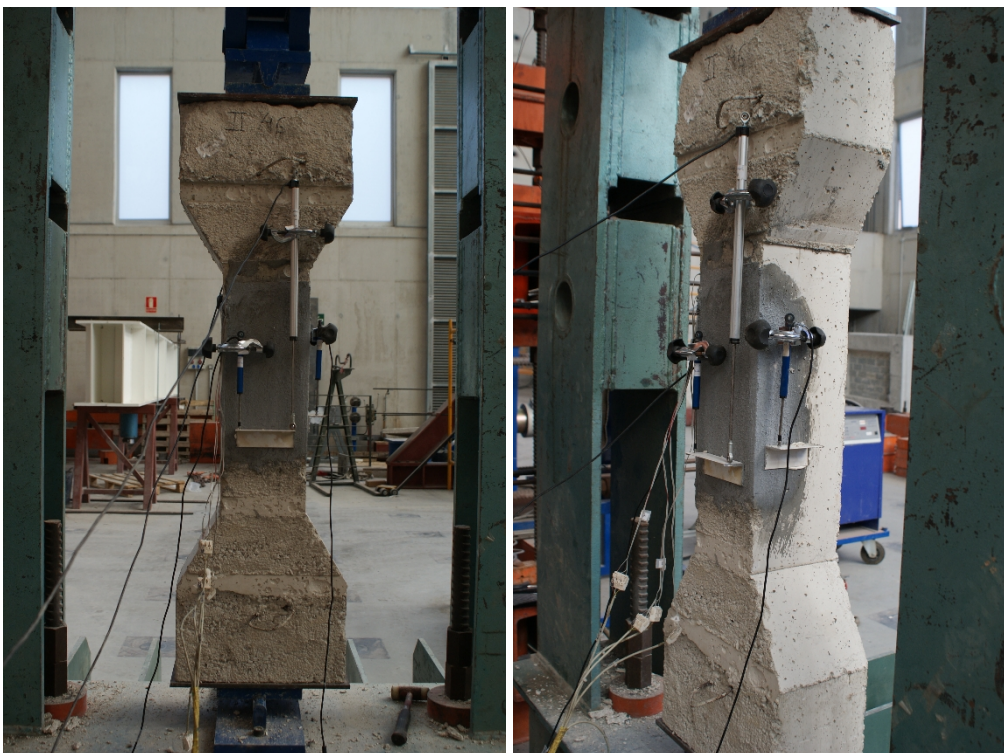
Colocación de la instrumentación en los pilares de parcheo, Cara C1 y C4 respectivamente.
